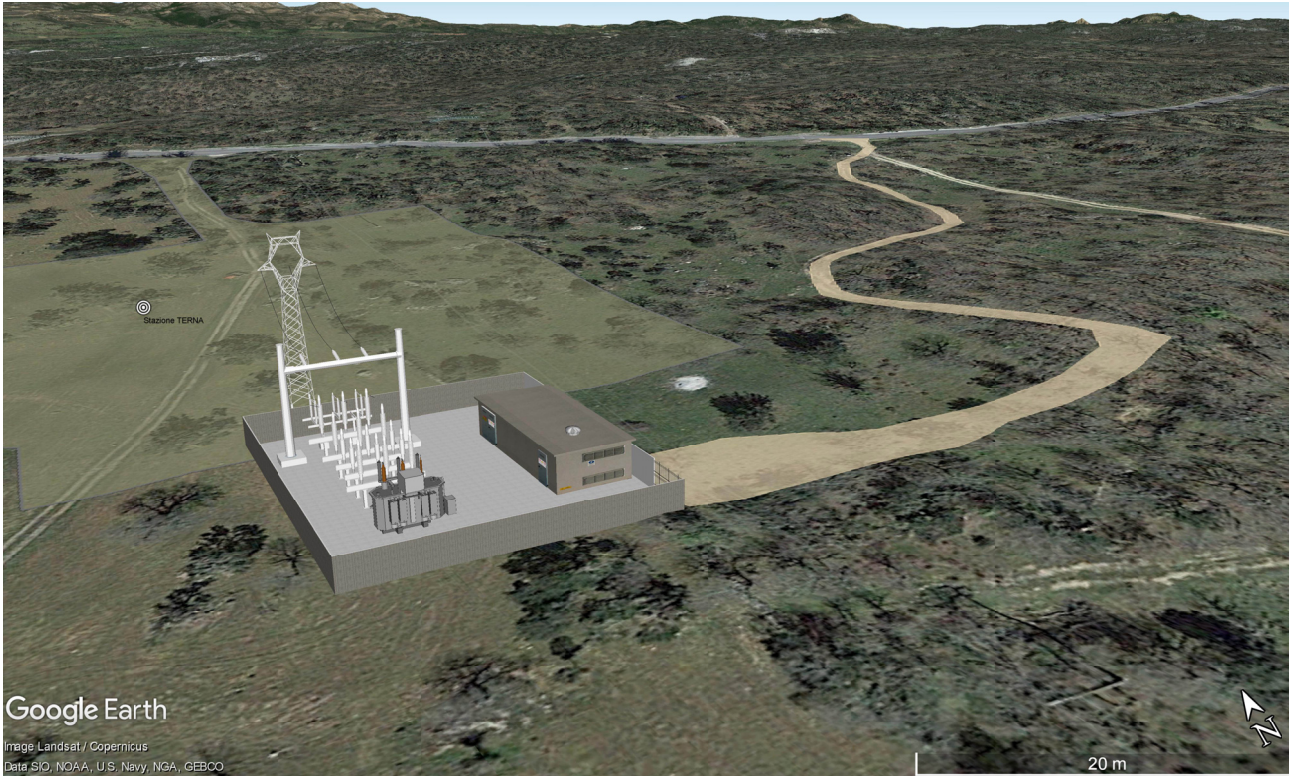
Rappresentazione 3D area stazione Utente Siemens Gamesa e relativa strada di accesso
